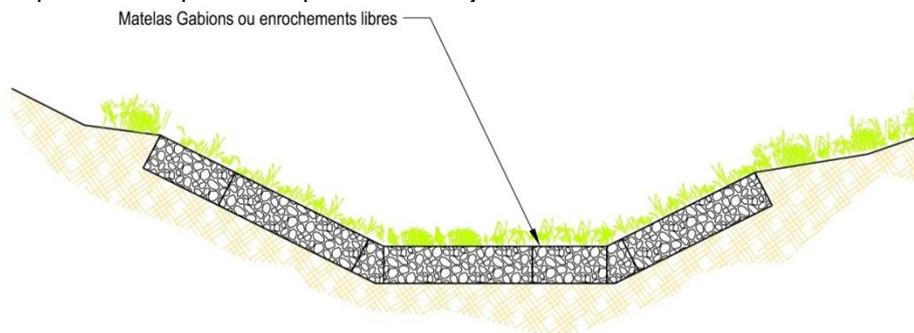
Coupe transversale type de l'ouvrage en entrée et en sortie de la fosse d'extraction
